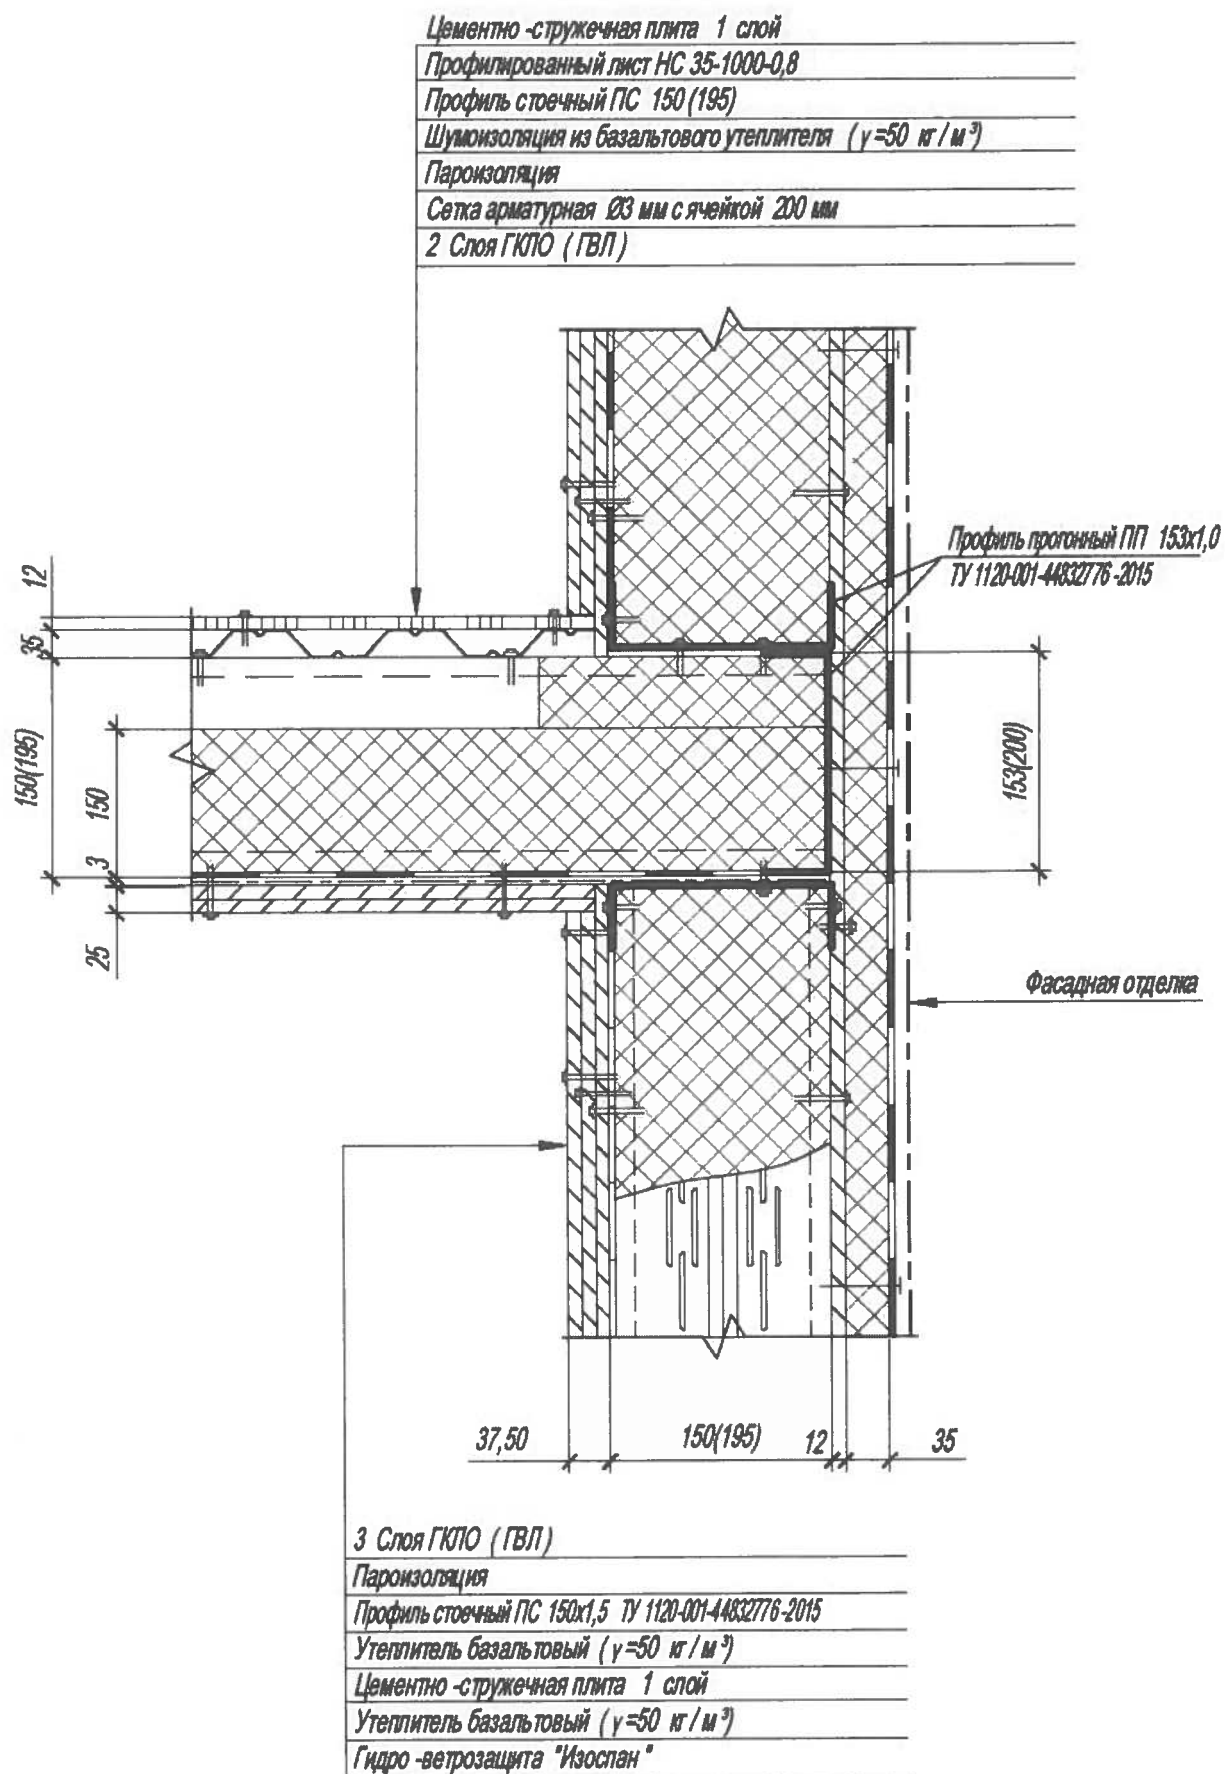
Узел крепления и опирания конструкции междуэтажного перекрытия на наружную несущую стену
